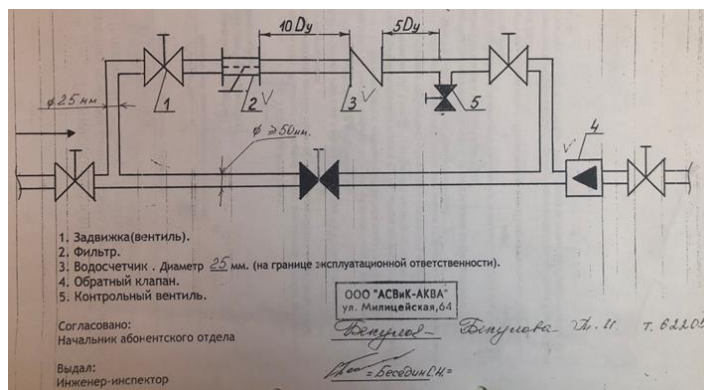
Схема внутреннего водовода лабораторного корпуса
